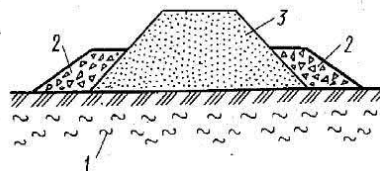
Увеличение устойчивости насыпи на слабых грунтах методом боковой пригрузки:
